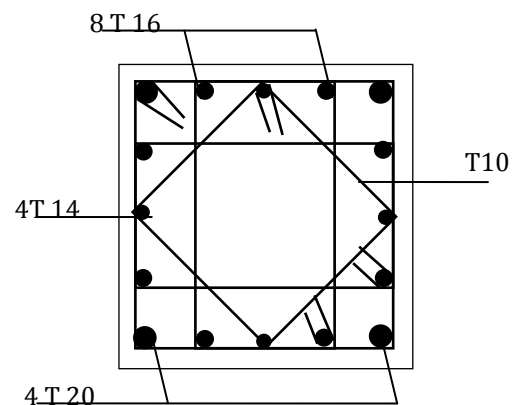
Schéma de ferrailage des poteaux 2<sup>ème</sup>, 3<sup>ème</sup> étage.
